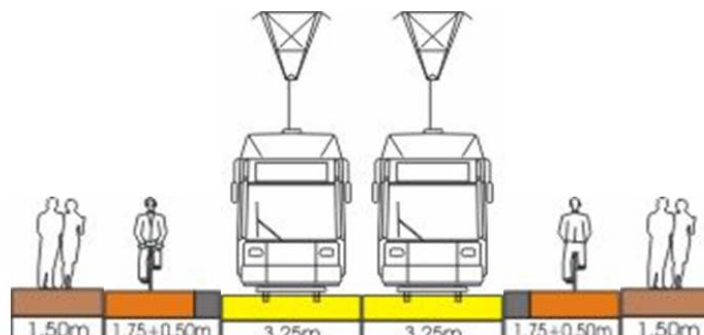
proposition d'un profil pour l'alternative – pont Picard avec transport public
